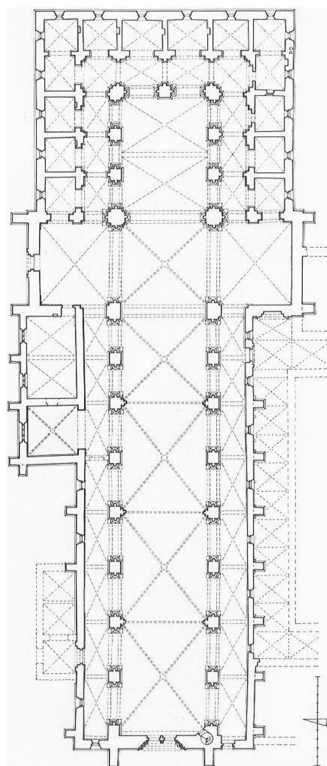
Riddagshausen, Grundriss (ab 1216).
